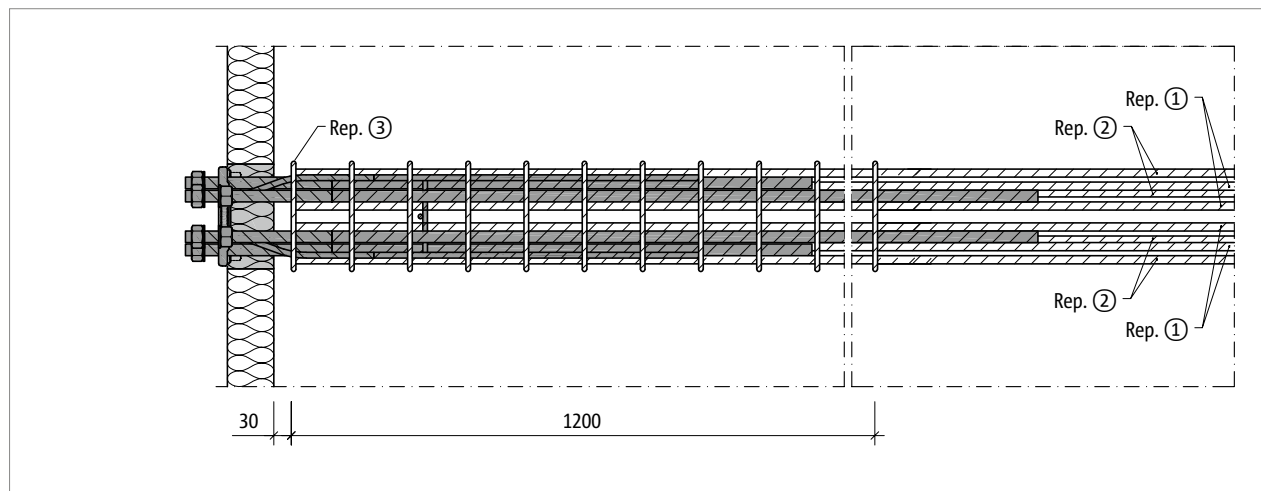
Schöck Isokorb® T type SK-MM2 : armatures à prévoir par le client, vue en plan
